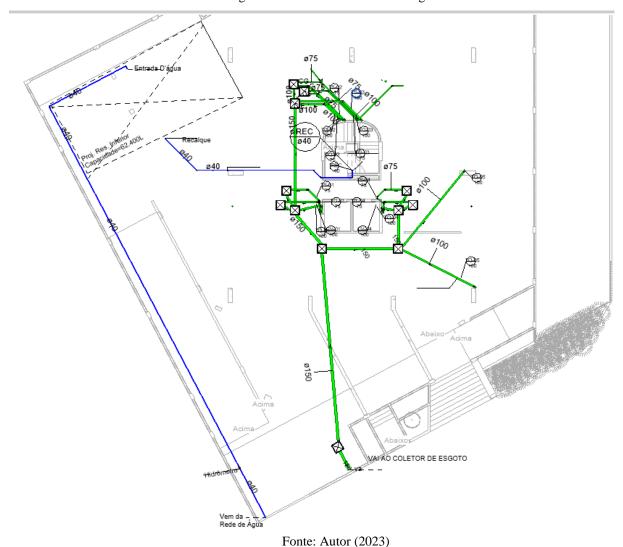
Planta baixa do pavimento semienterrado, no qual observa-se todo detalhamento dos ramais de coleta de esgoto e rede de abastecimento de água fria.
